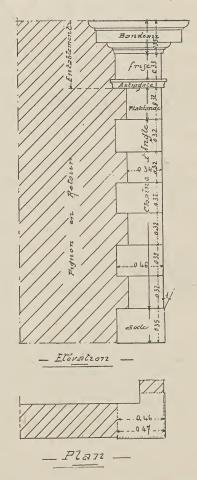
Plan et élévation de la chaîne d'angle en retour.
